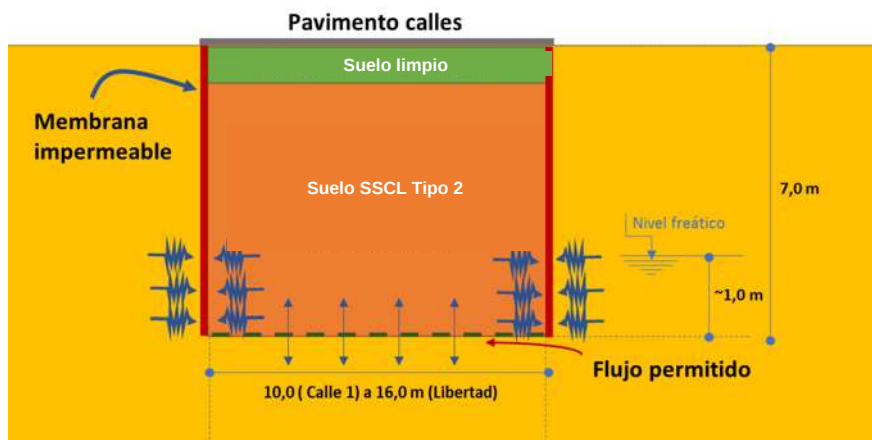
Perfil de suelos requerido bajo el trazado de las calles proyectadas en el PRC de Viña del Mar.
